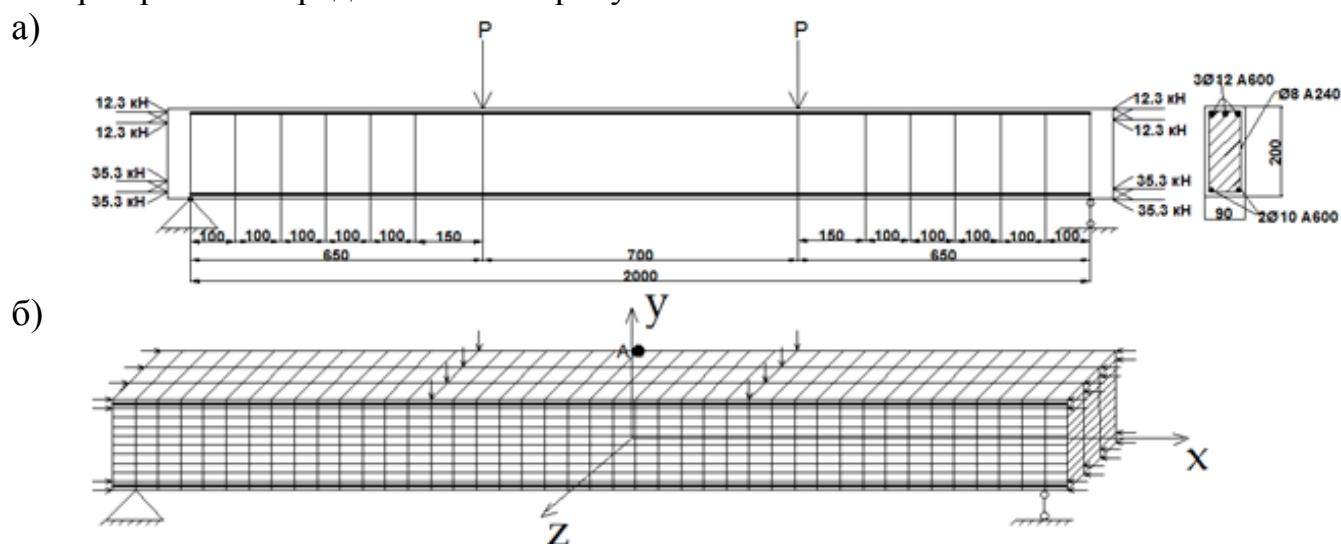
Модель балки: а - расчетная схема и конструкция железобетонной балки, б – схема разбивки на конечные элементы.
